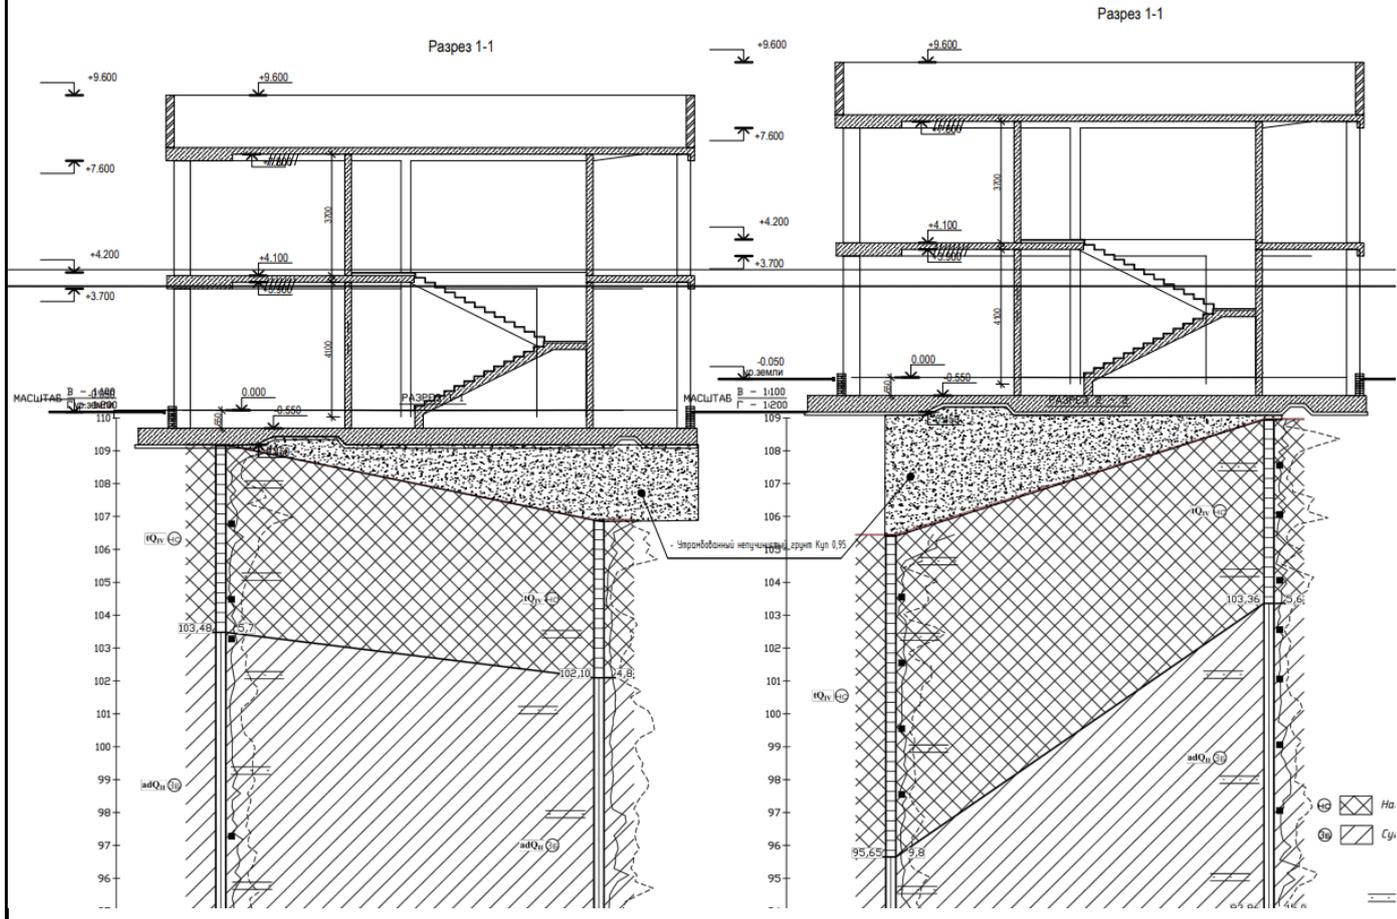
Инженерно-геологический разрез с посадкой фундамента здания
